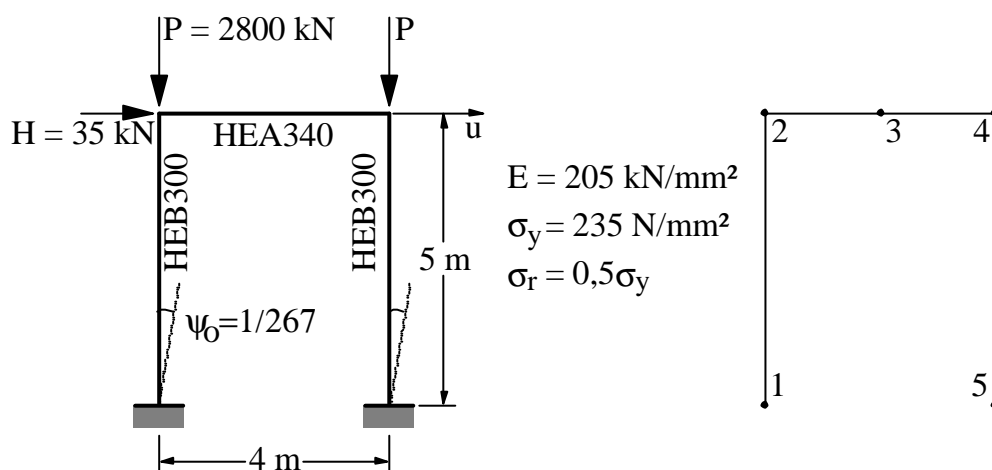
Pórtico simples de Vogel e malha de EF utilizada.
